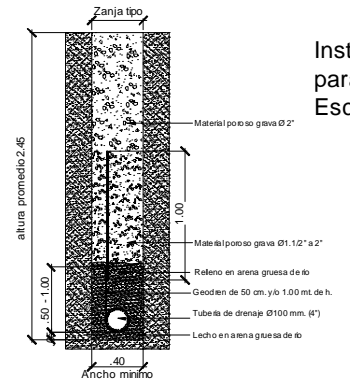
Filtros, drenajes y alcantarillado pluvial semisotano
